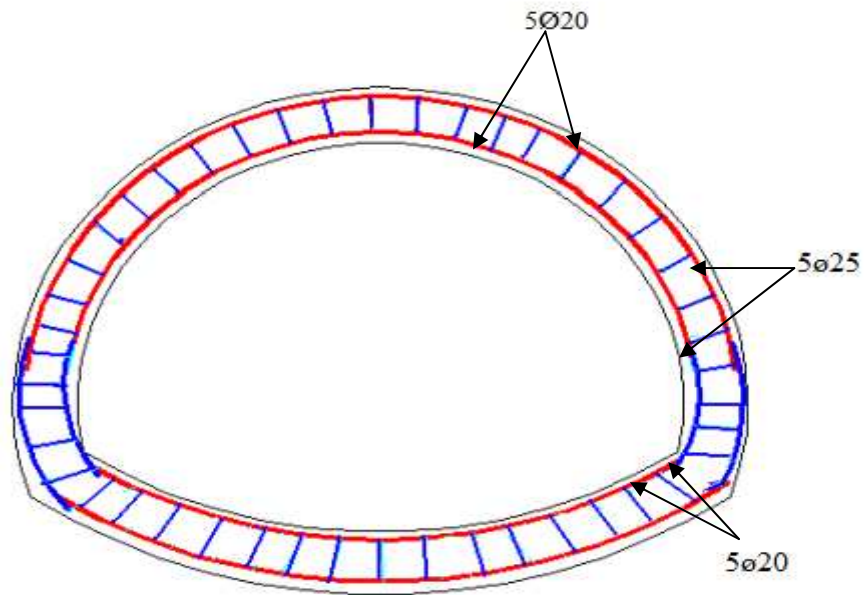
Disposition de ferrailage dans les différents éléments
